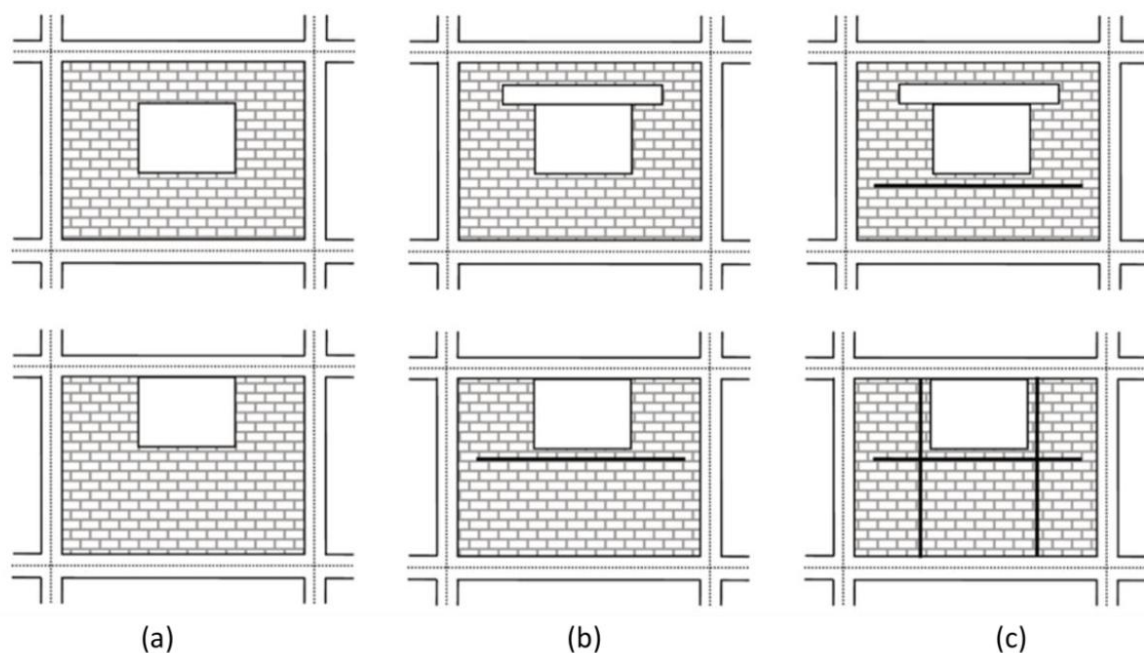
(a) aberturas não armadas, (b) aberturas parcialmente armadas, (c) aberturas armadas, retirado de prEC8-1-2 (2025)
